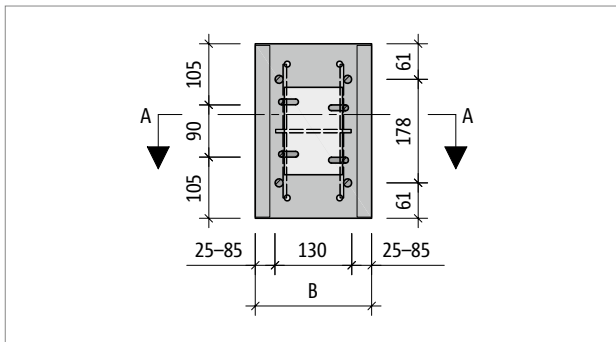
Schöck Sconnex® Typ W-NT1-V1H1: Produktgrundriss
